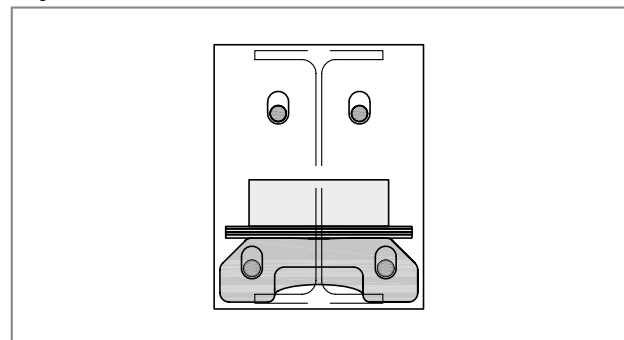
Schöck Isokorb® T type SK : les entretoises de la plaque d'absorption de la charge surélèvent l'emplacement de la poutre en acier de 20 mm maximum.
